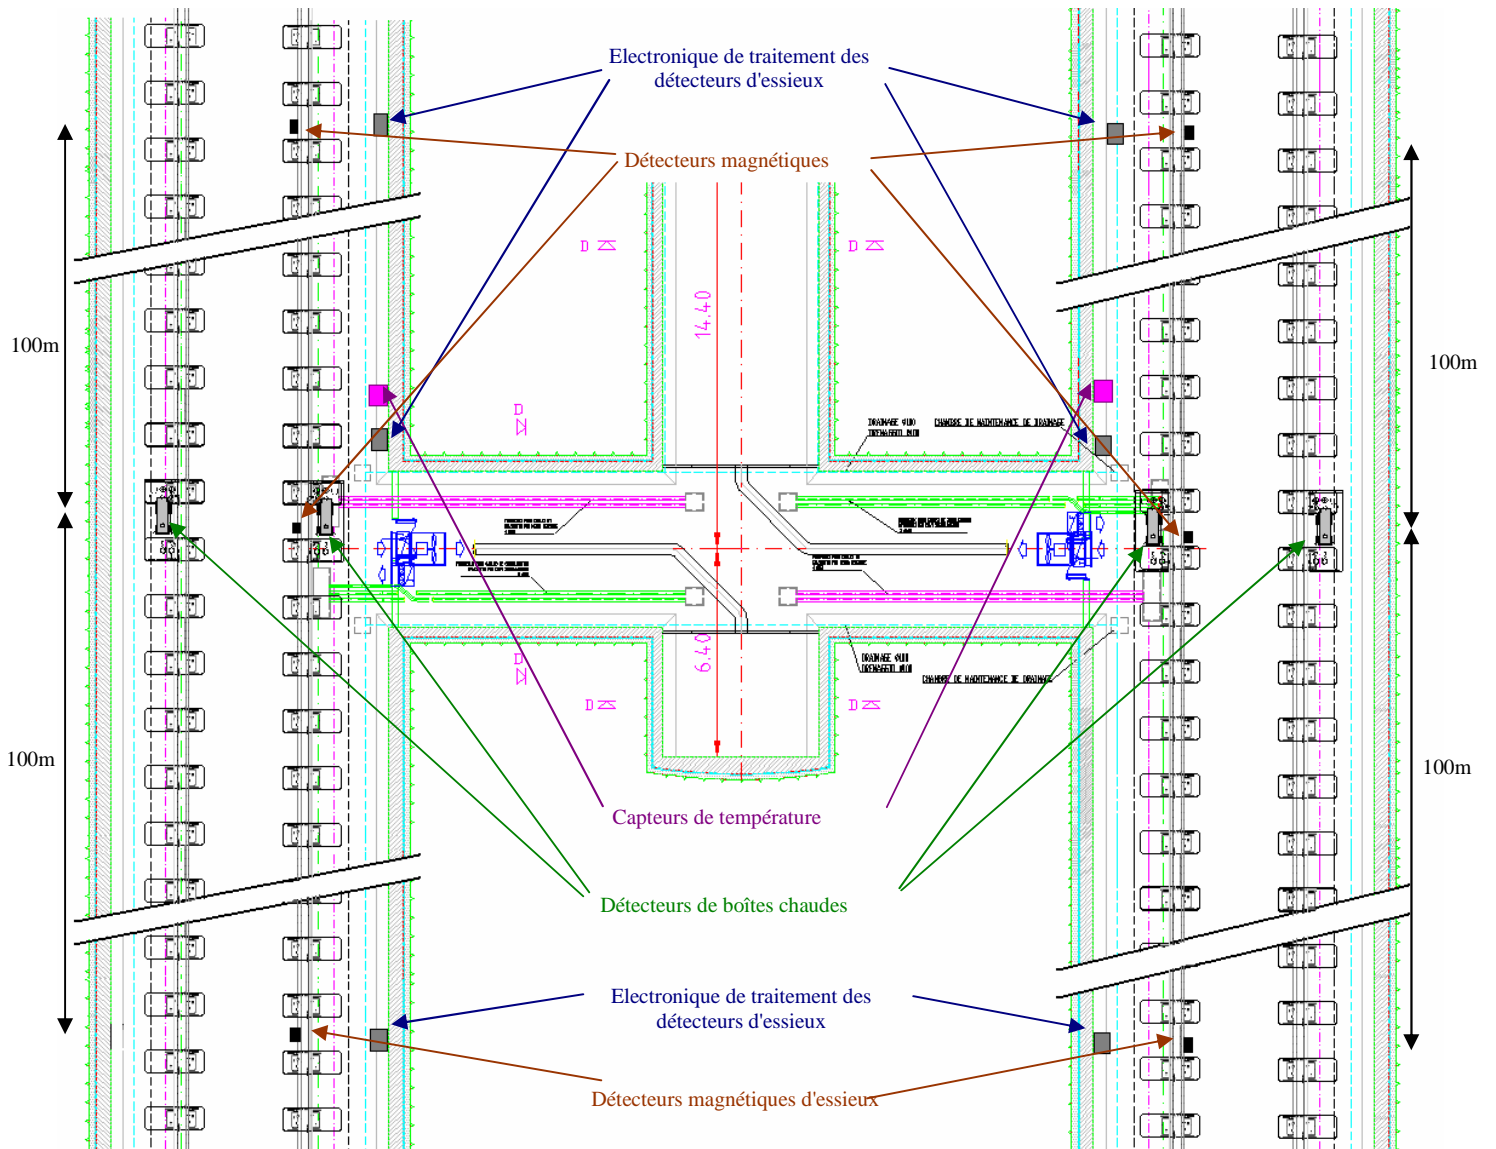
Plan d'implantation des capteurs pour le système de DBC en tunnel
